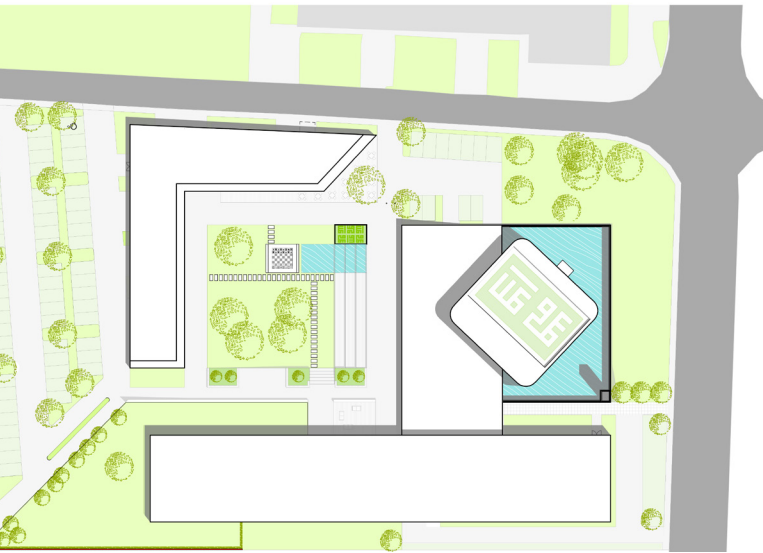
, Abb. 59: Lageplan und Grundriss des Islamischen Kulturzentrums in der Laubgasse in Graz, Architekturbüro: gsp architektur ZT GmbH, 2011, unmaßstäblich.
